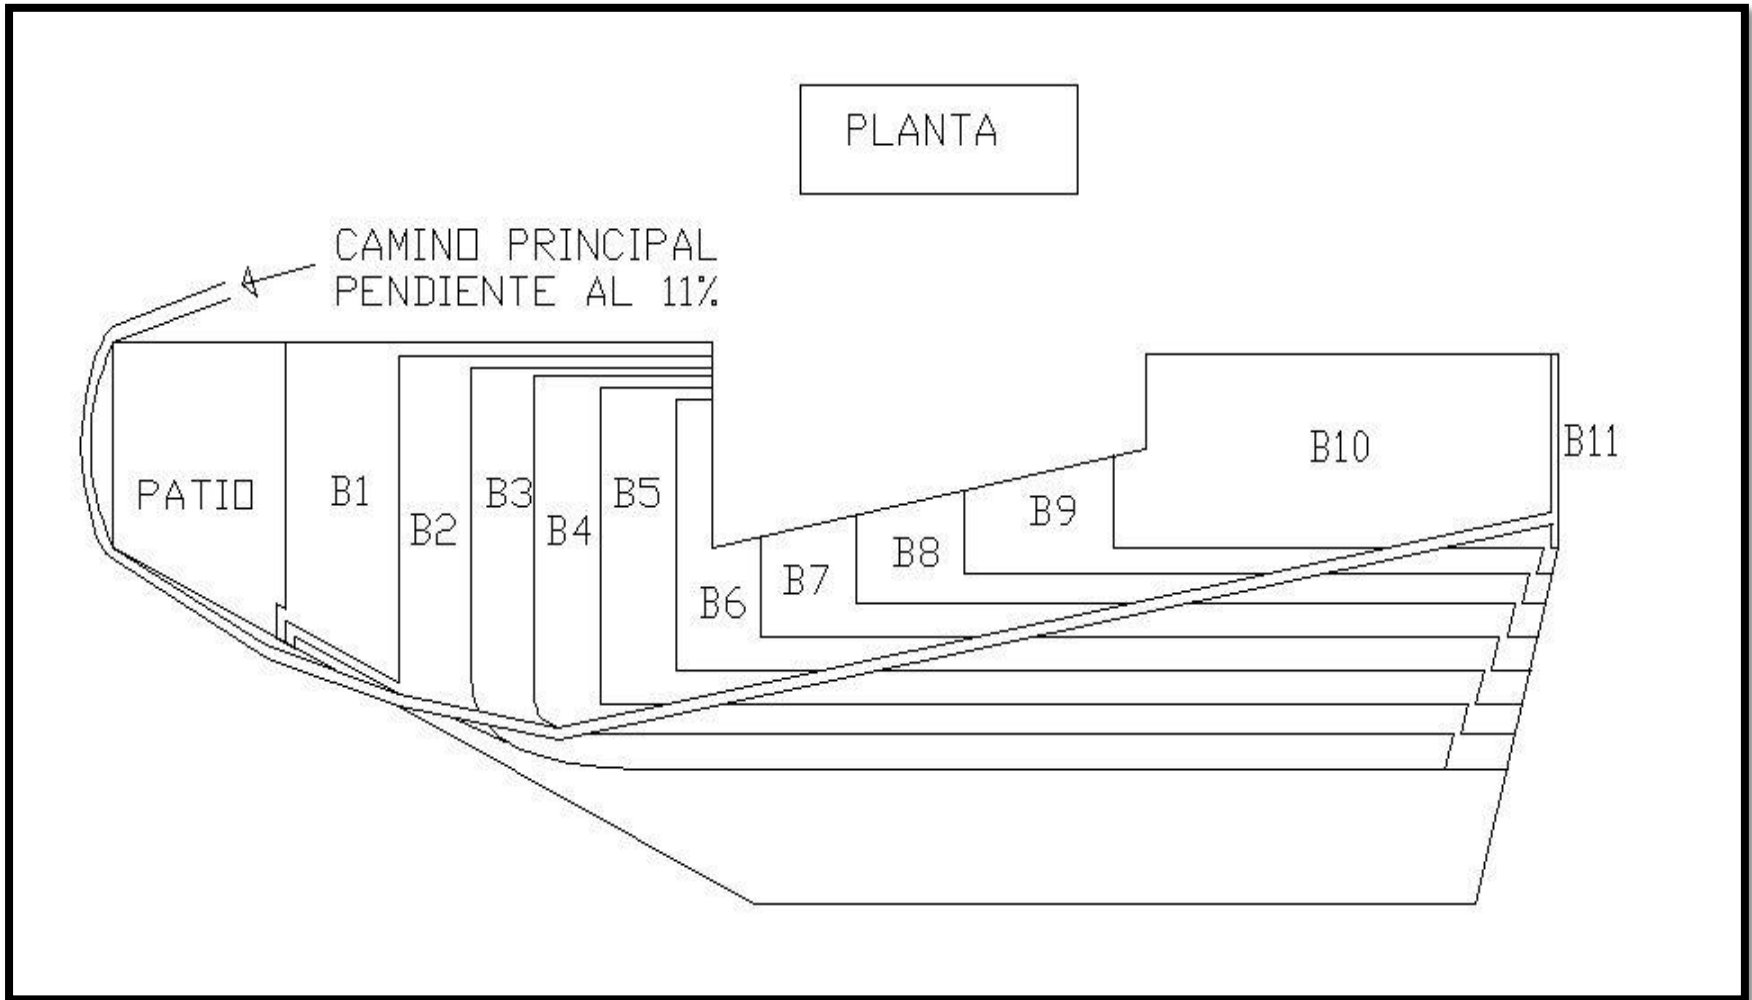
Vista de planta. Configuración de bancos y camino principal.
